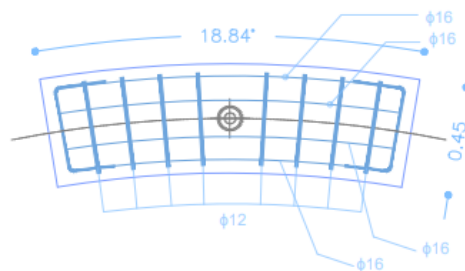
Plano Llave – Armadura Sección Transversal – Dirección Longitudinal
